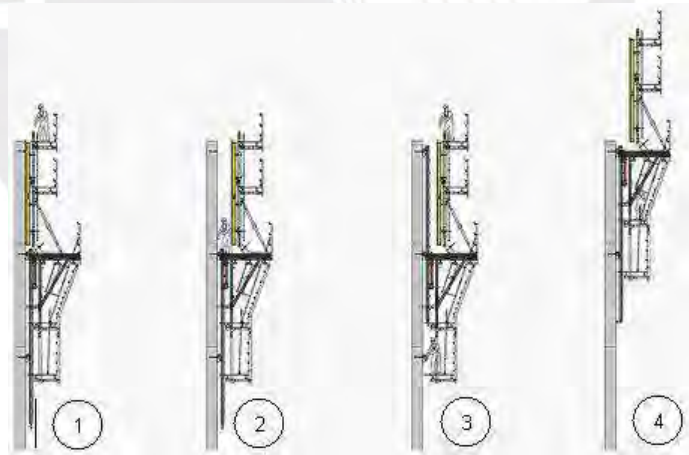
Encofrado autotrepante (secuencia de trepado)
